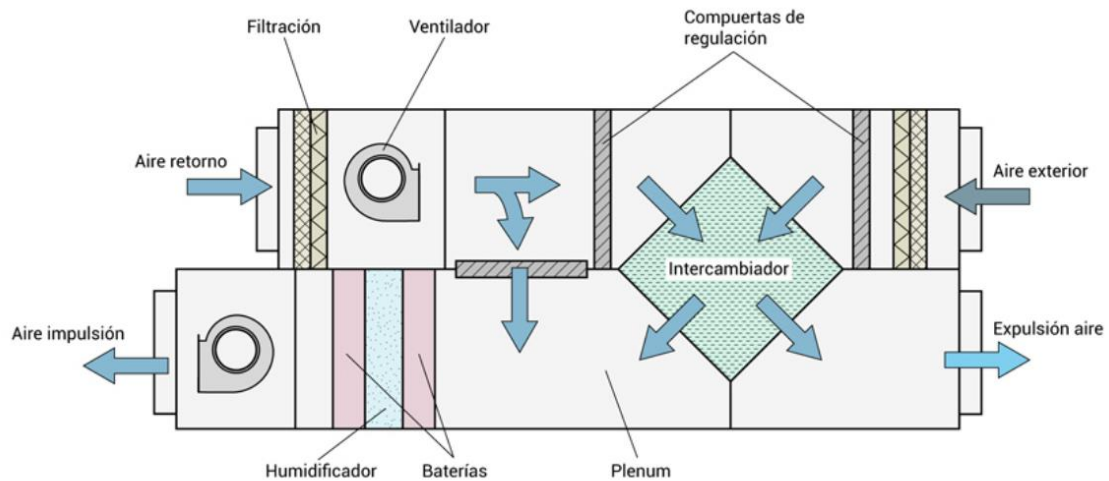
Componentes principales de una UTA. Fuente: Airtecnicos.
